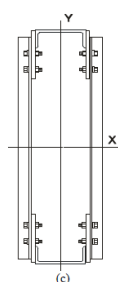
Seção transversal de vigas treliçadas (Nogueira, 2009).
